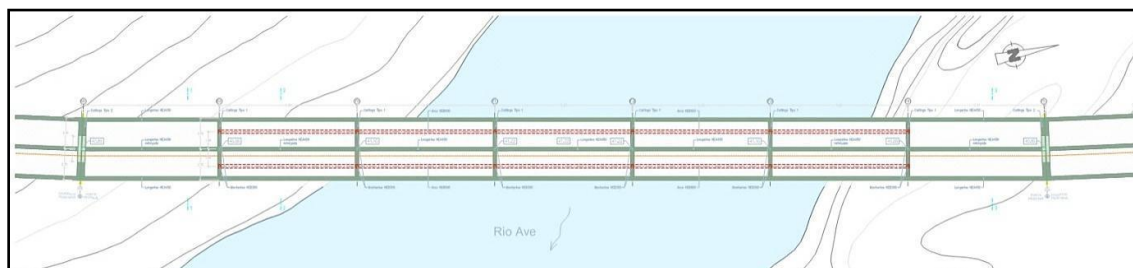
Traçado em planta da ponte pedonal [23]
